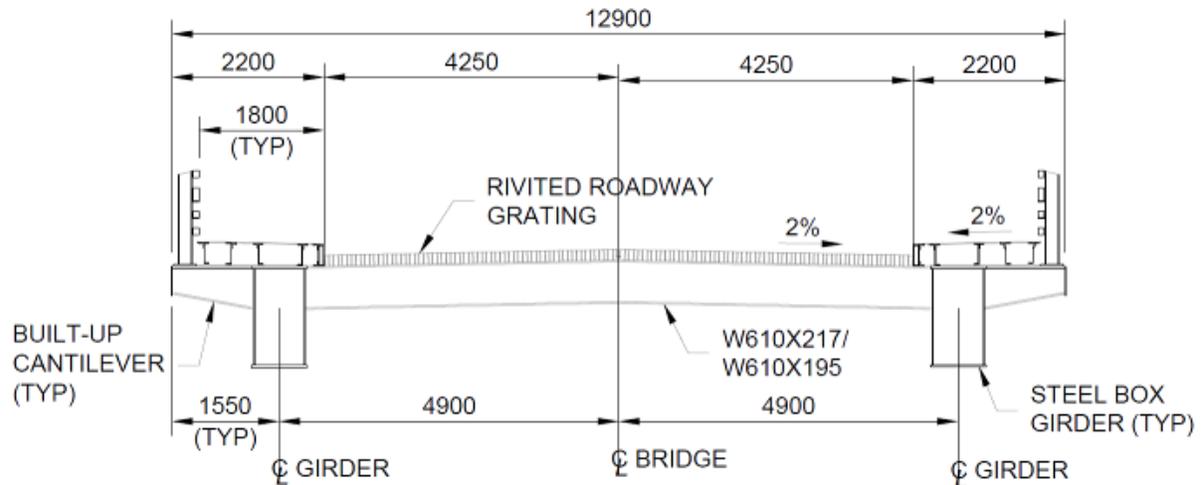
Coupe transversale de la travée levante – option caillebotis en acier riveté
